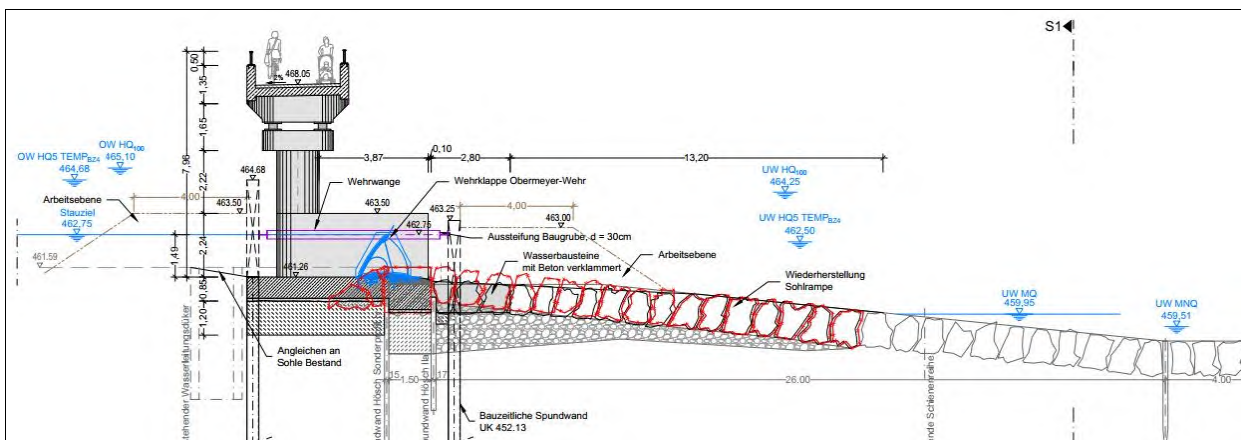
Querschnitt Wehr (Obermeyer-Wehr) mit Rampe und Ersatzneubau Steg (Quelle: IB Fichtner 2024b, Plan Schnitt Wehranlage 4-4)
